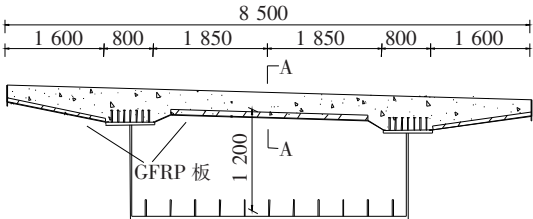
GFRP—混凝土—钢箱梁断面图(单位:mm)
